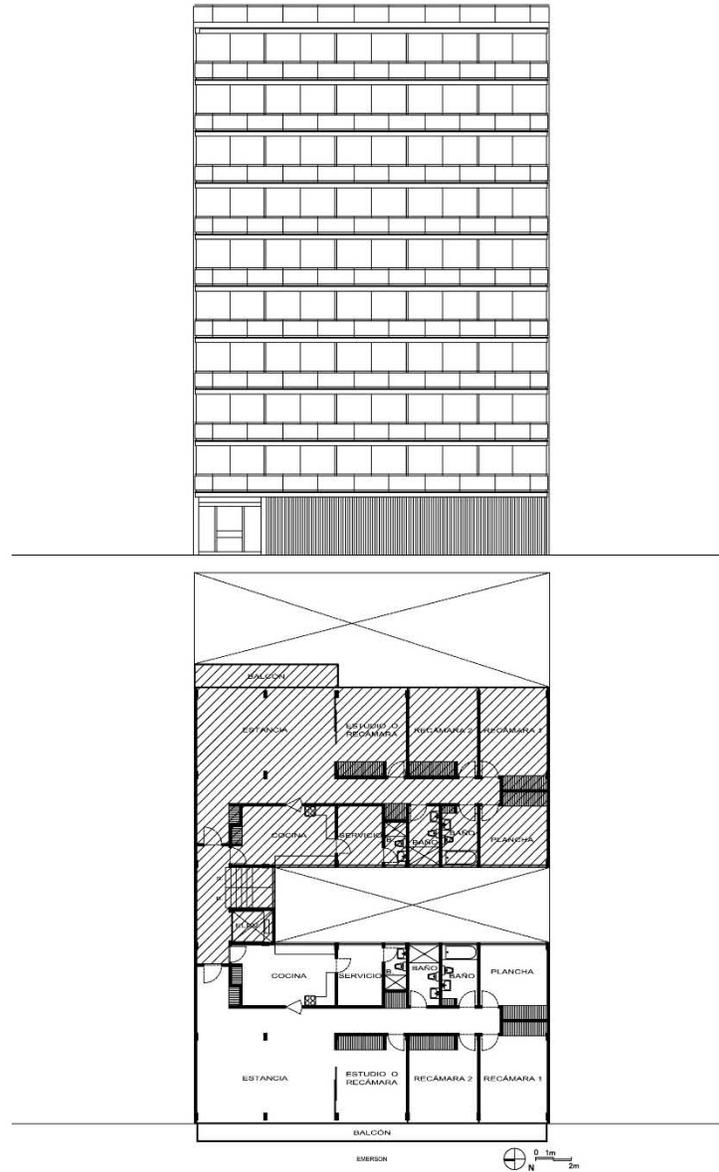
Fachada y planta del edificio ubicado en Emerson núm. 228
